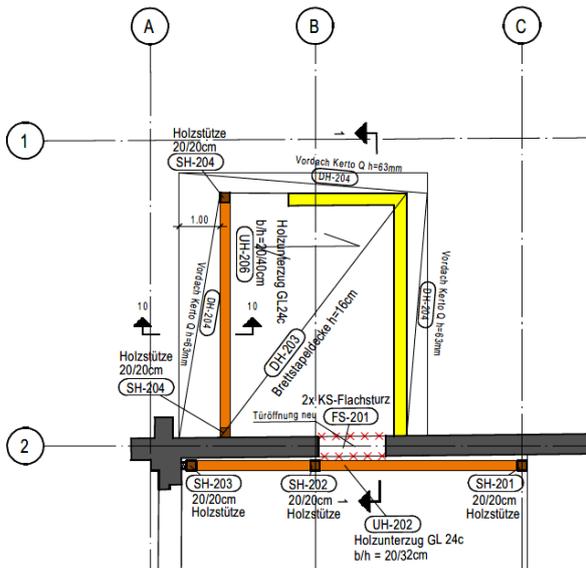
Grundriss Detail [Walter Reif Ing. GmbH]
